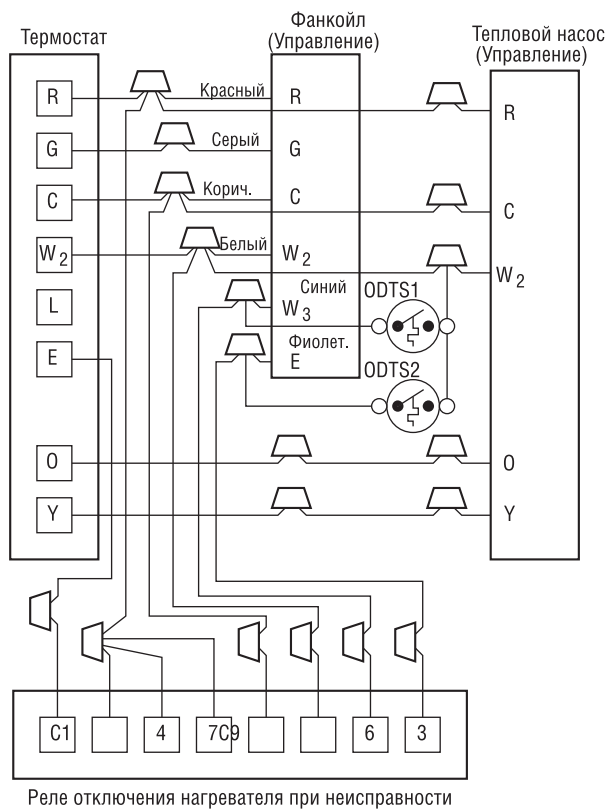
монтажная схема подключения реверсивного холодильного агрегата (охлаждение и 2 уровня нагрева с двумя внешними термостатами)
